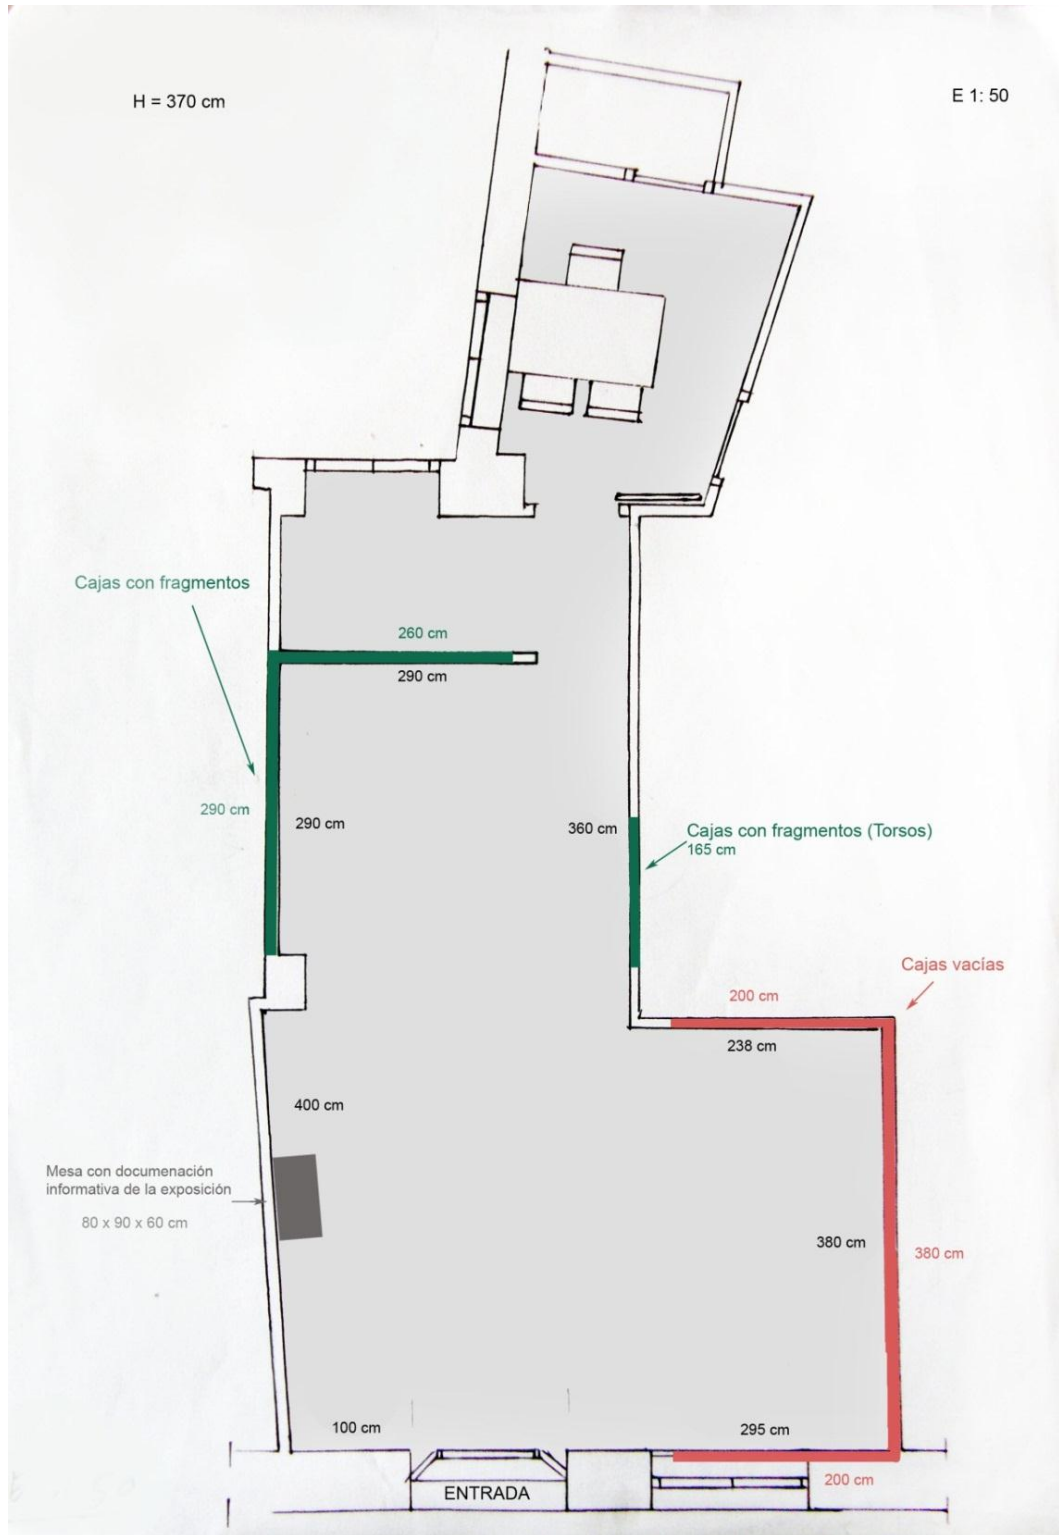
Plano de la Galería Alejandro Bataller con la ubicación de las piezas.
